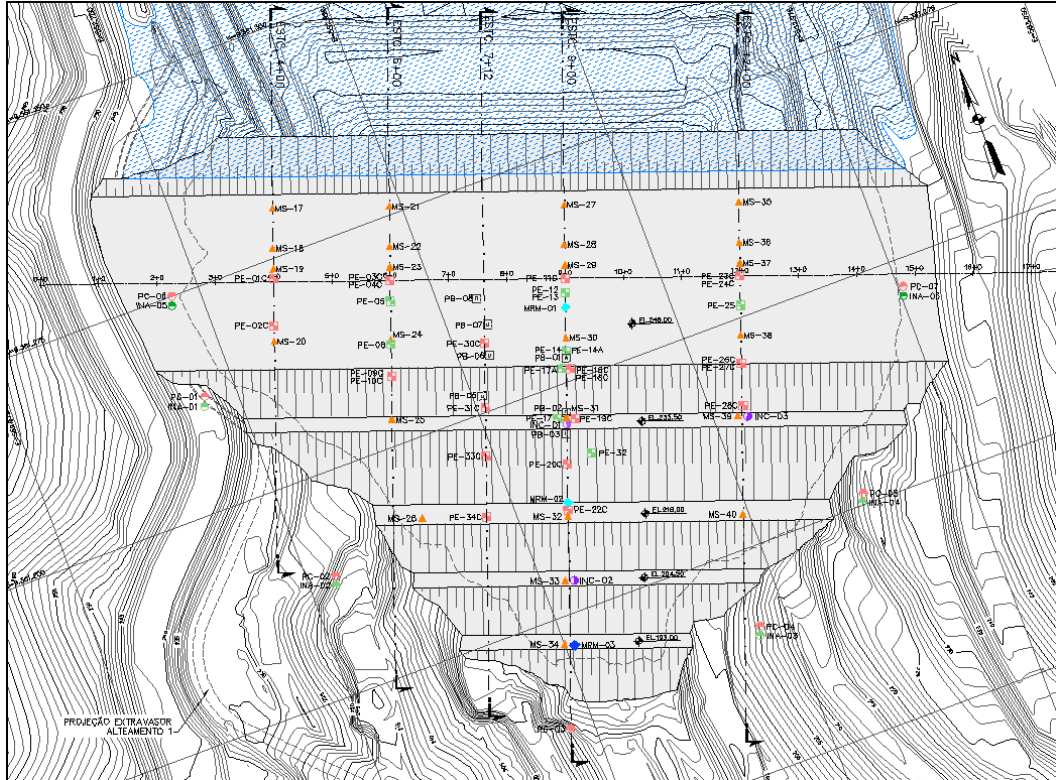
Planta de Localização das Seções de Análise – EL. 245 m
